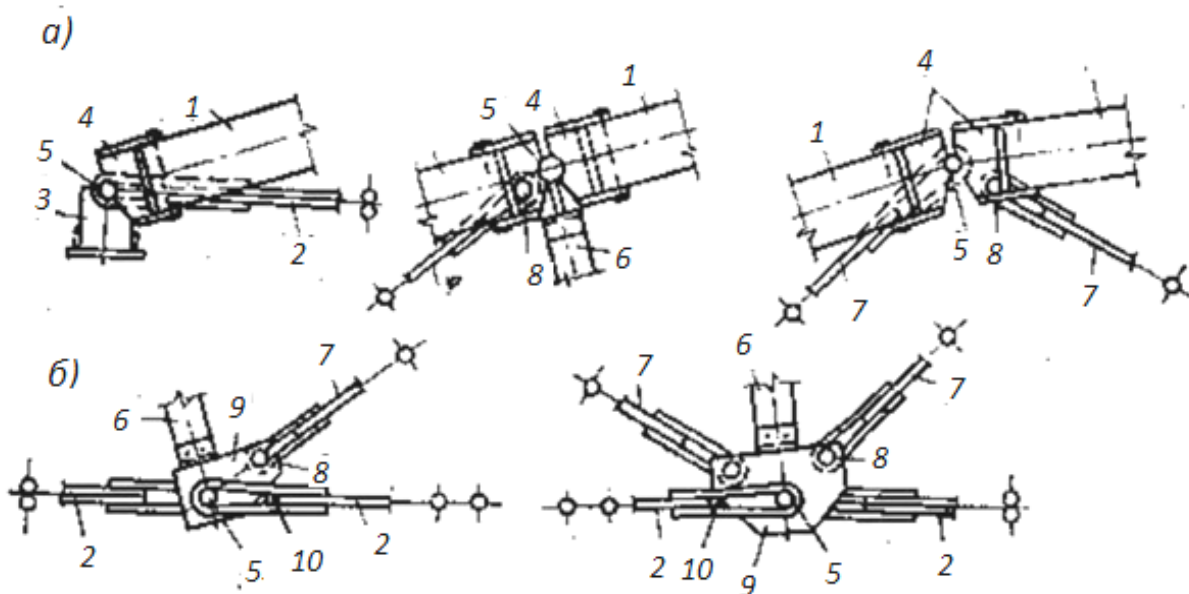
Узлы соединения элементов нижнего пояса и раскосов деревометаллических ферм с брусчатым верхним поясом:
